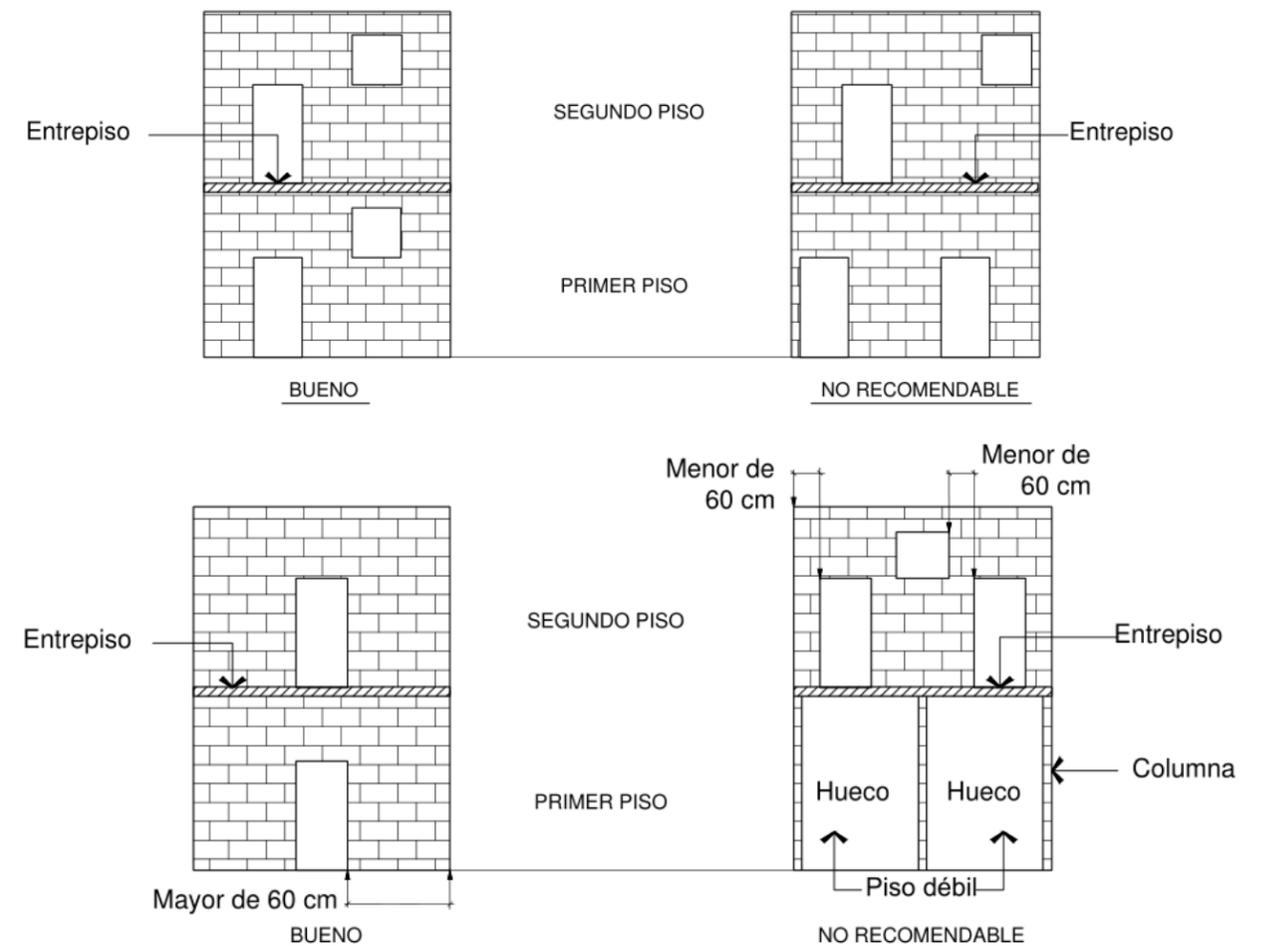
Elevaciones correctas de mampostería confinada. Fuente: equipo de trabajo
